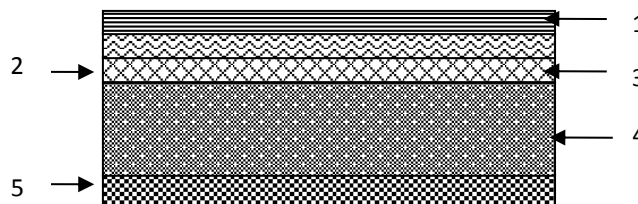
Coupe transversale dans le plancher à dalle pleine.
